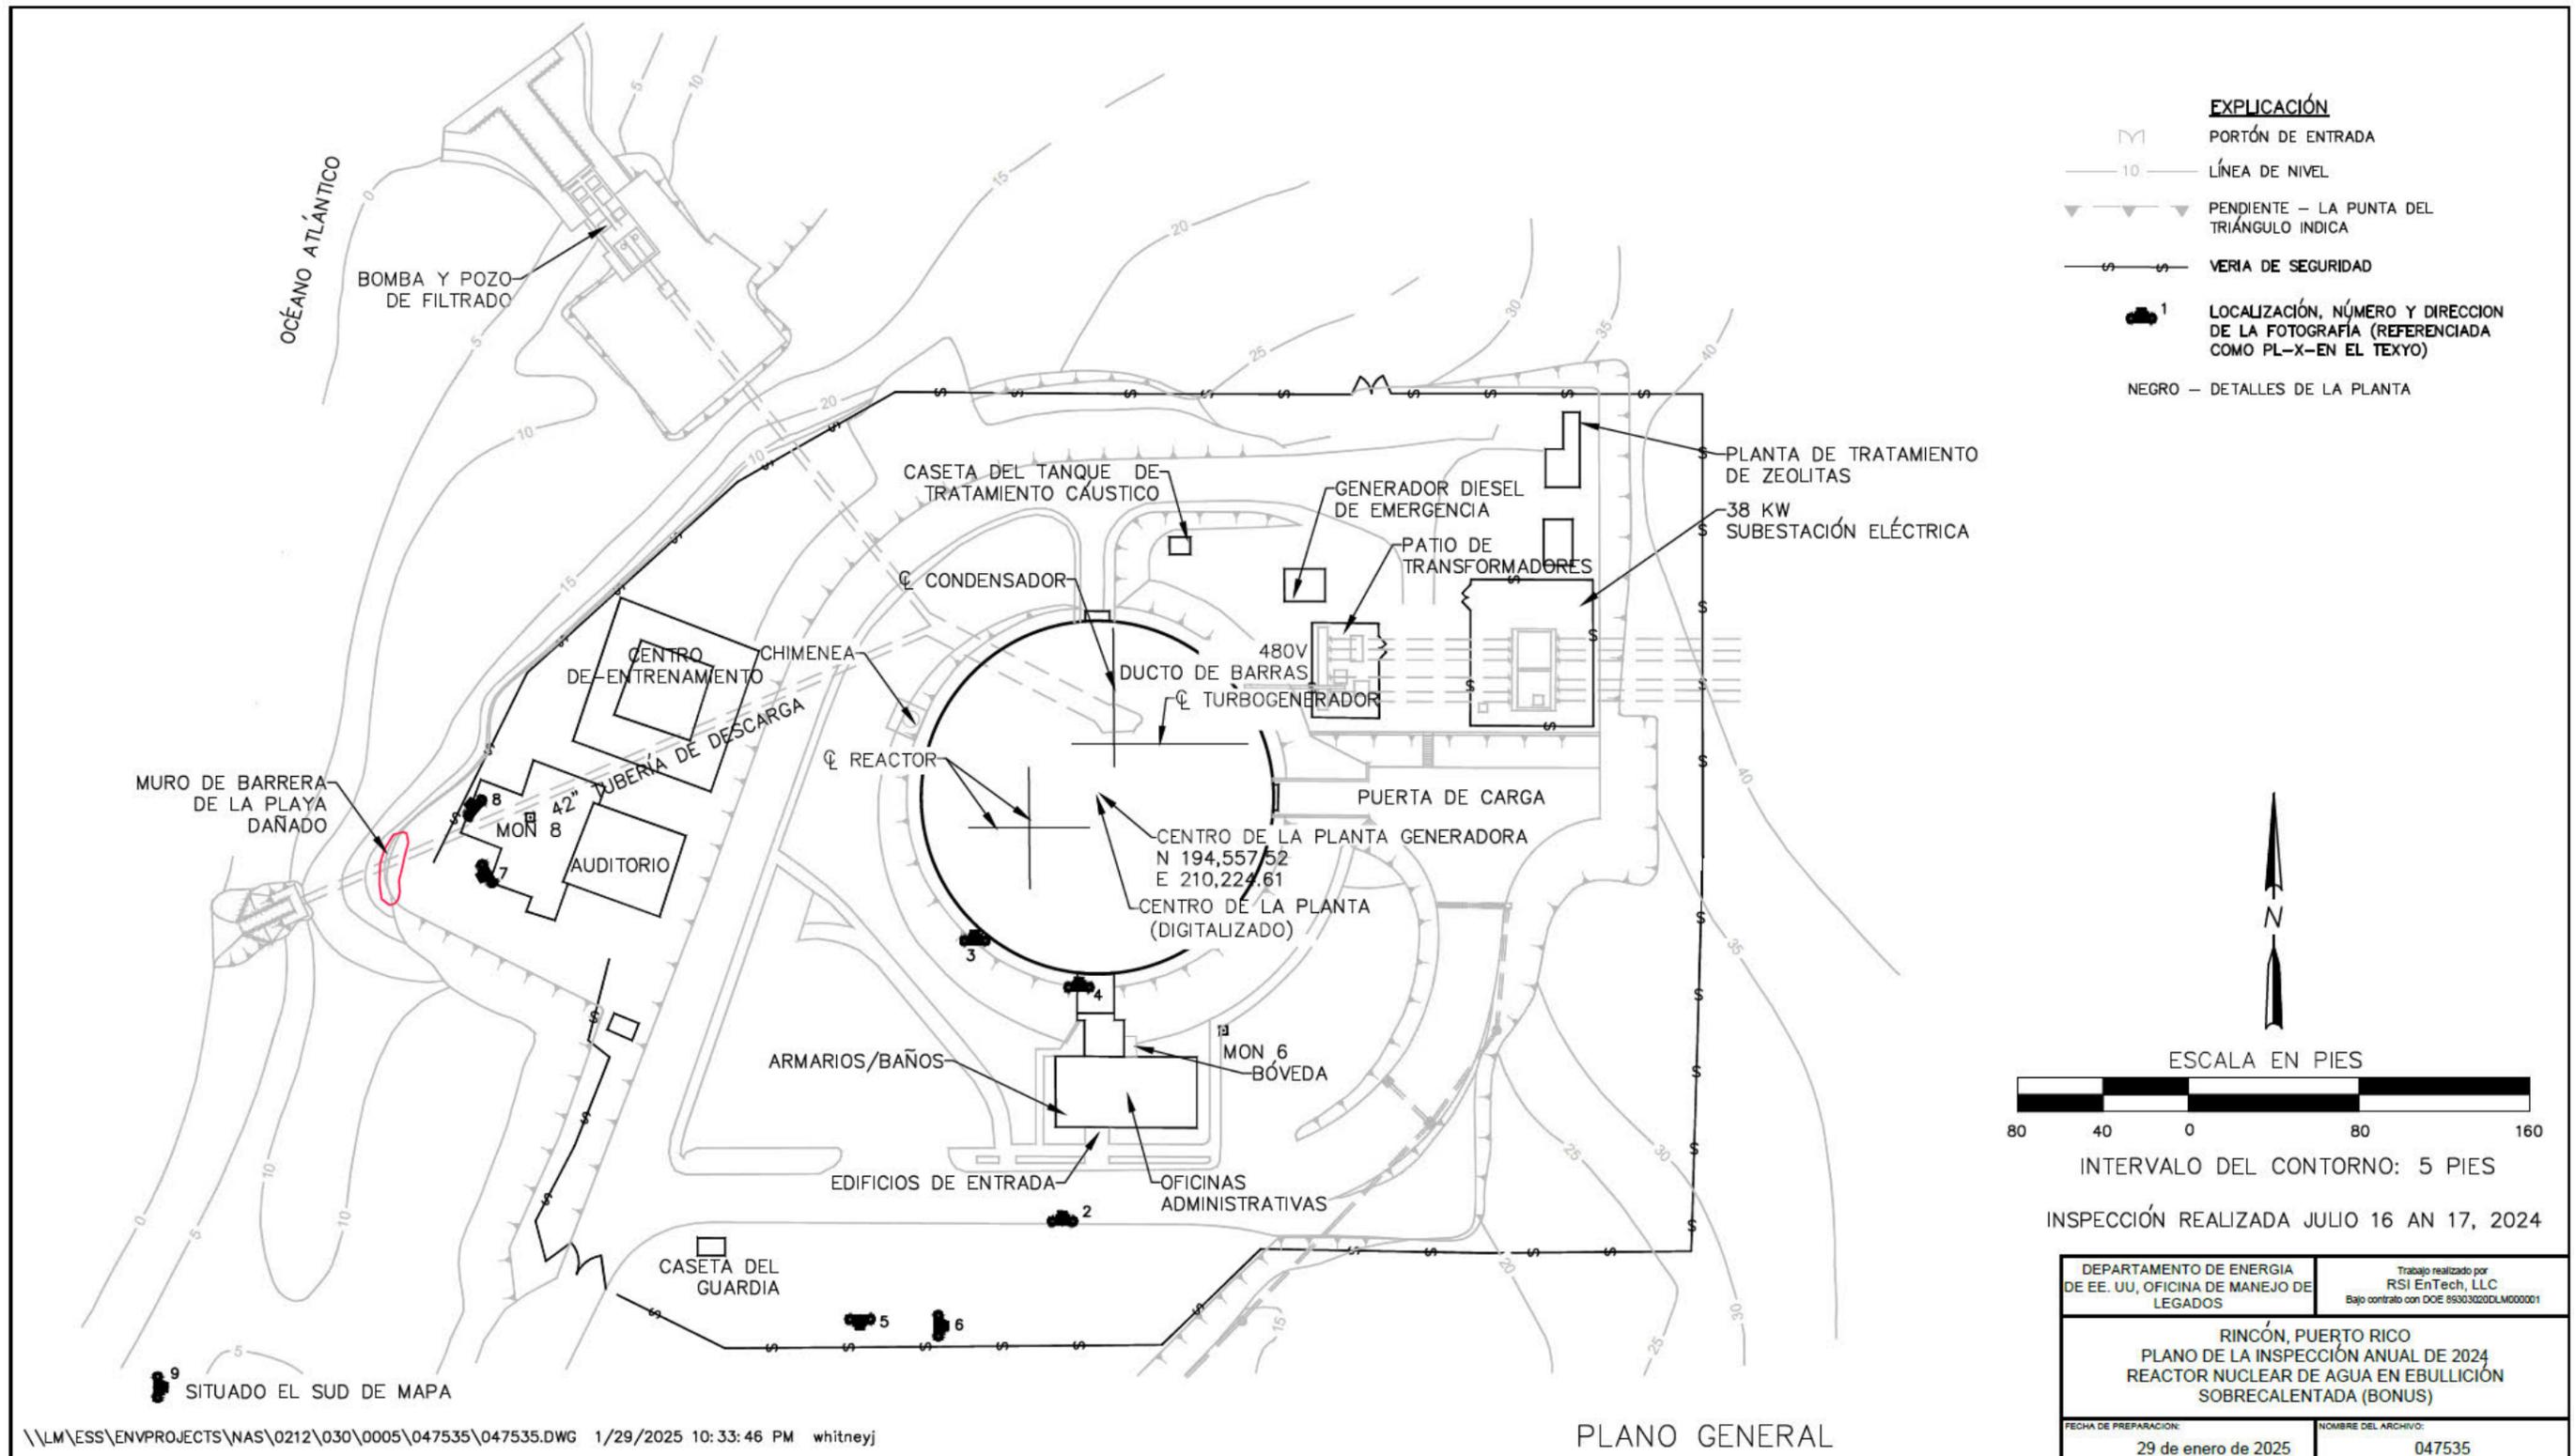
Plano general de la Planta BONUS, Rincón, Puerto Rico
